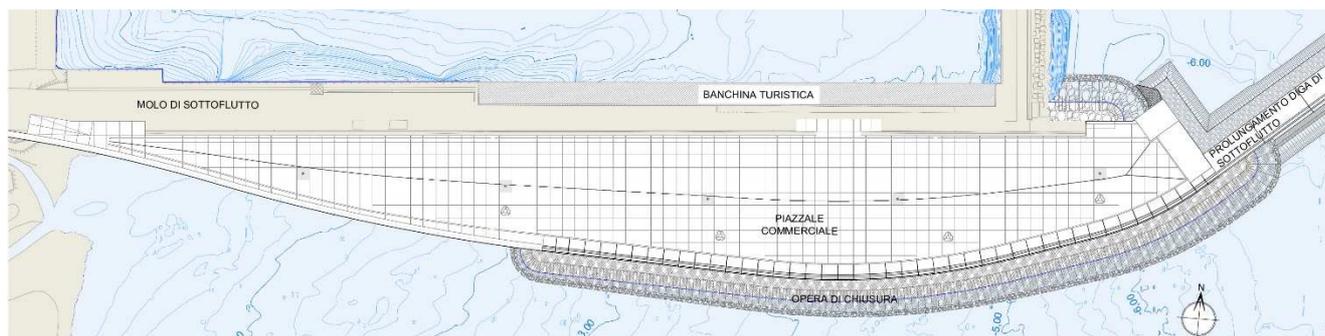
Piazzale Operativo - Planimetria generale di progetto
